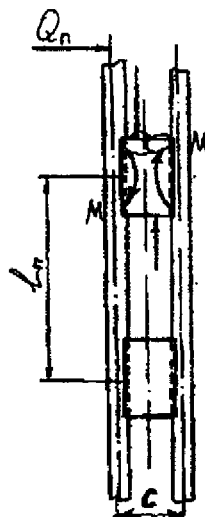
Схема усилий при расчете планок стальных опор.
